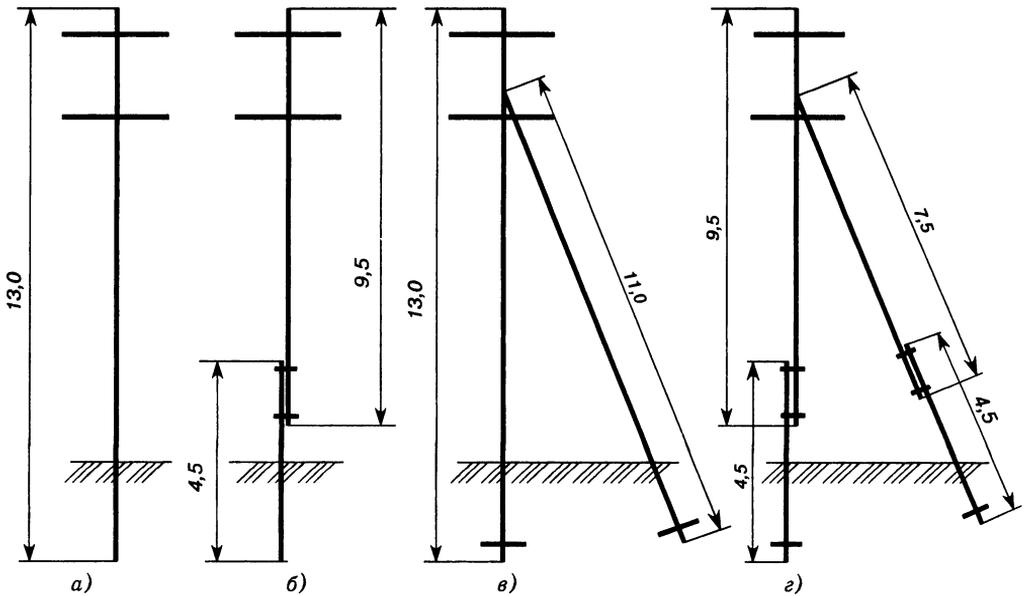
Схемы деревянных опор для совместной подвески проводов ВЛ 0,4 и 10 кВ по типовому проекту 3.407–92.
